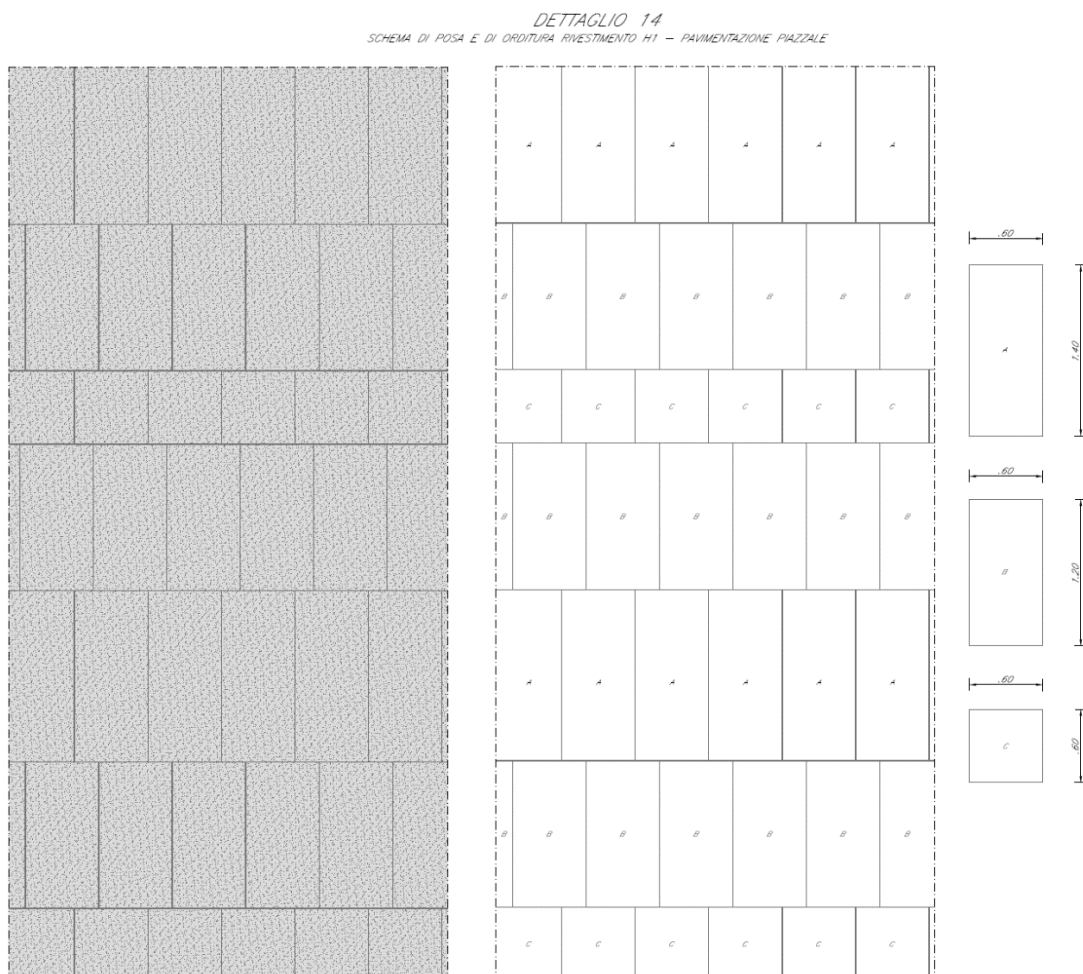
Schema di posa e di orditura pavimentazione piazzale
